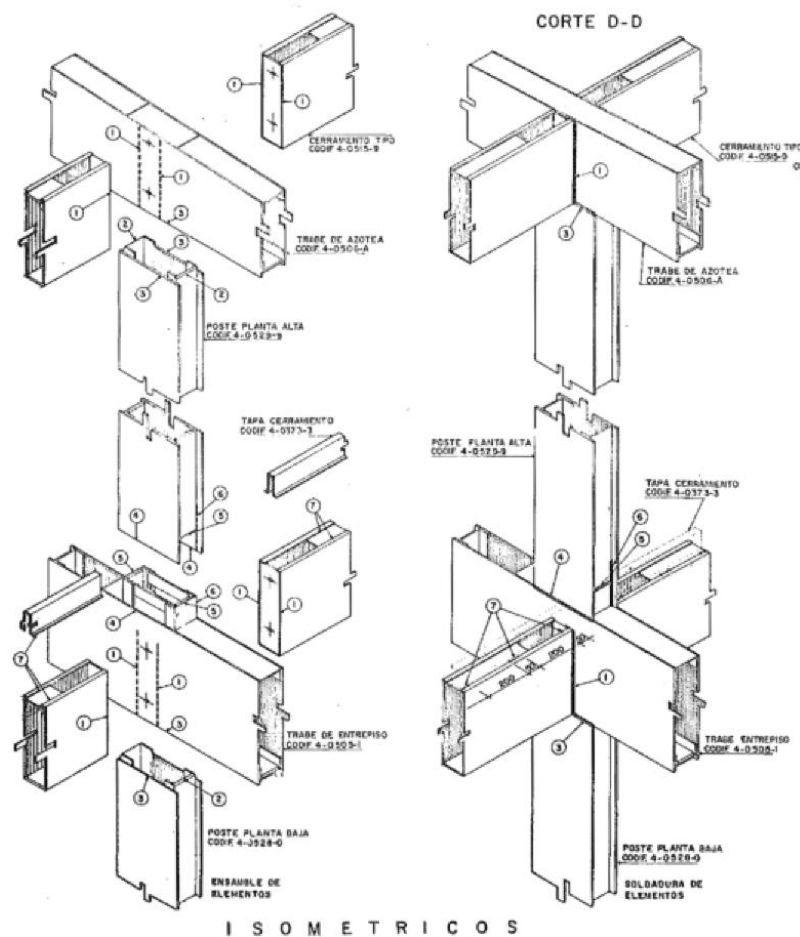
conexión columna-trabe-cerramiento.
